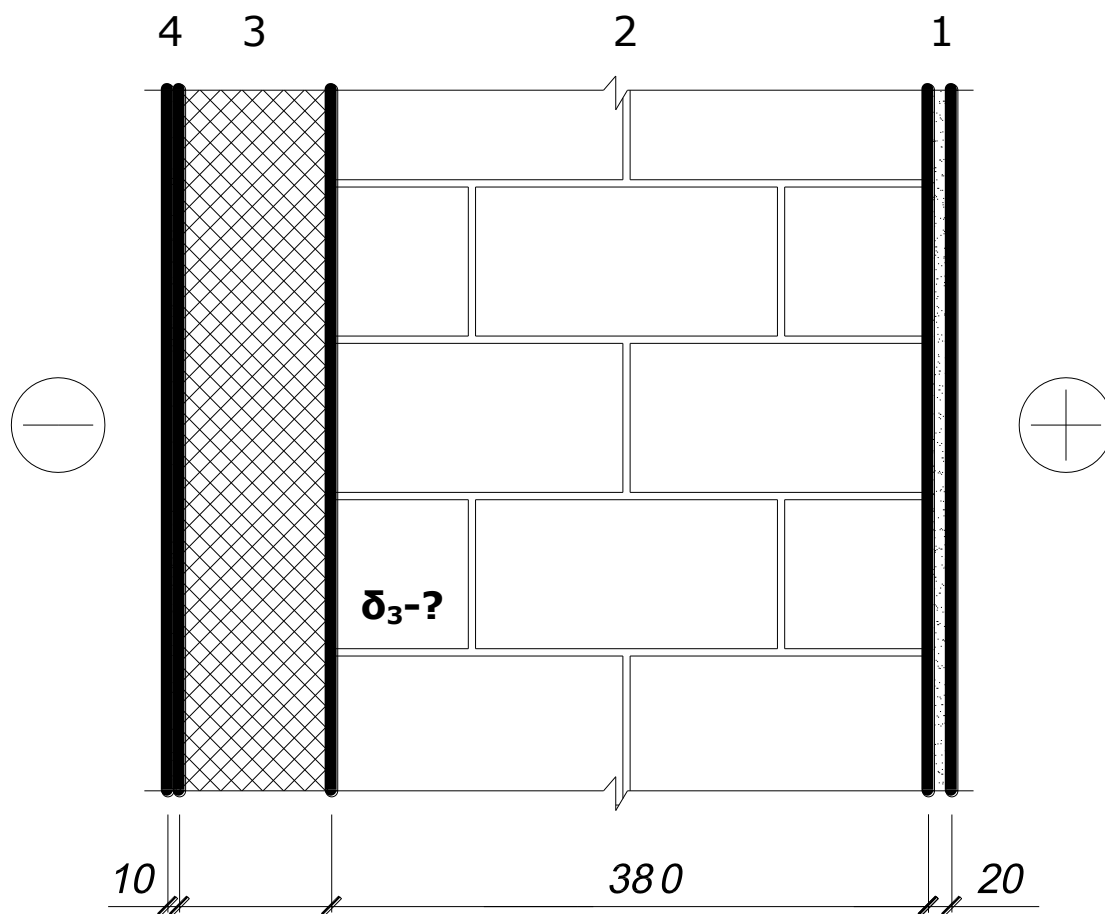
Розрахункова схема зовнішньої стіни житлової будівлі
